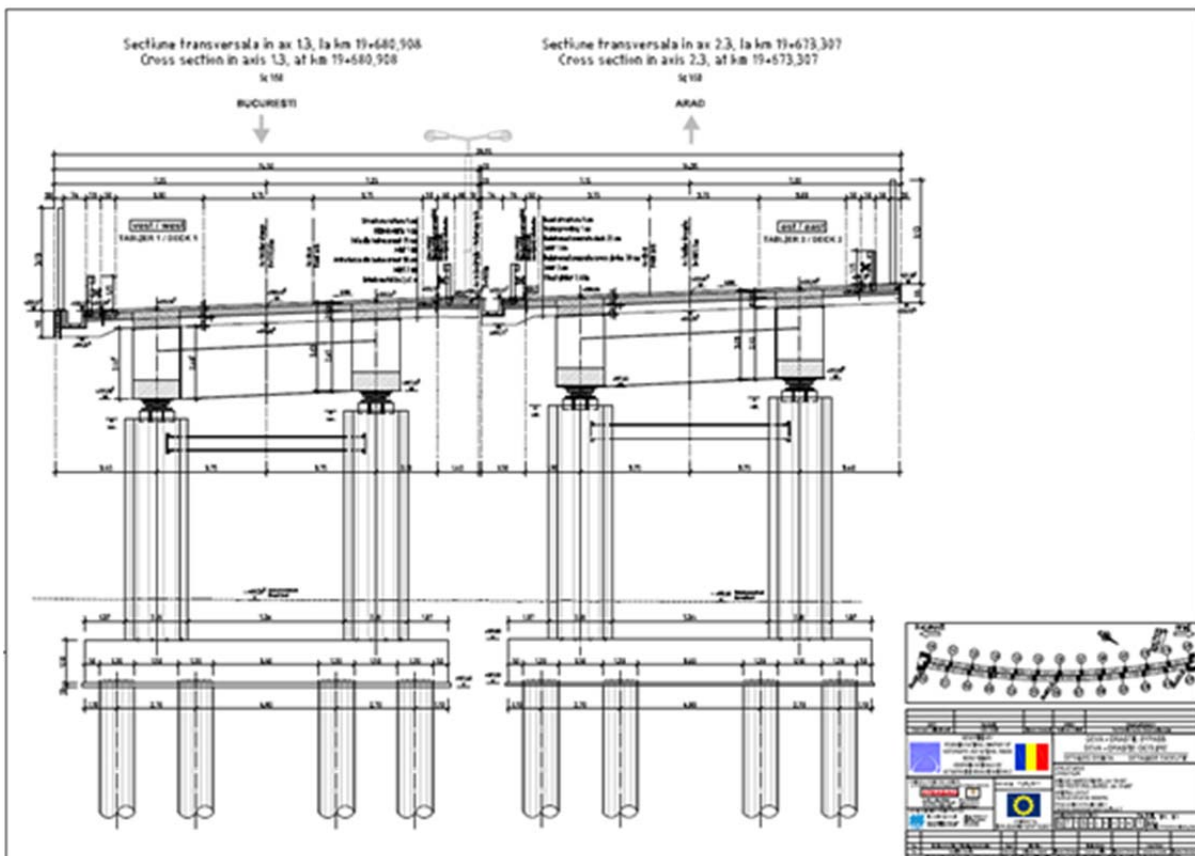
Schnitt durch die Brücke mit Fundamenten und Installationen [4]
